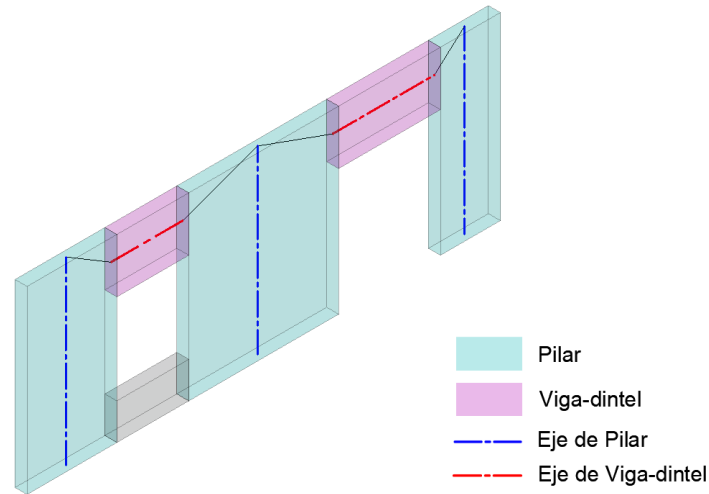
Identificación de los elementos estructurales de un muro de mampostería
